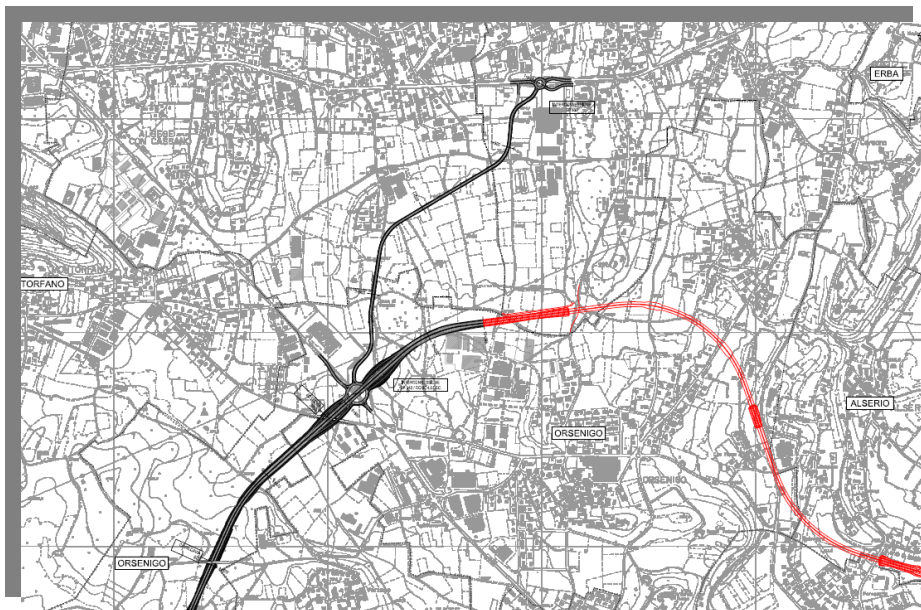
Ipotesi con collegamento alternativo al secondo lotto della “Tangenziale di Como”
